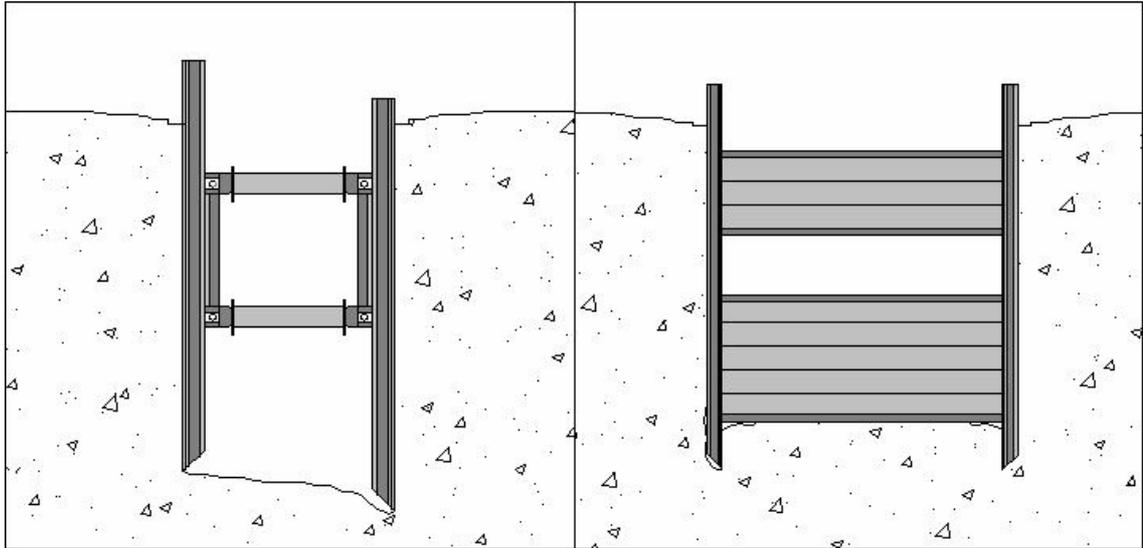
Finalización del montaje y colocación del primer módulo y sus paneles deslizantes.
